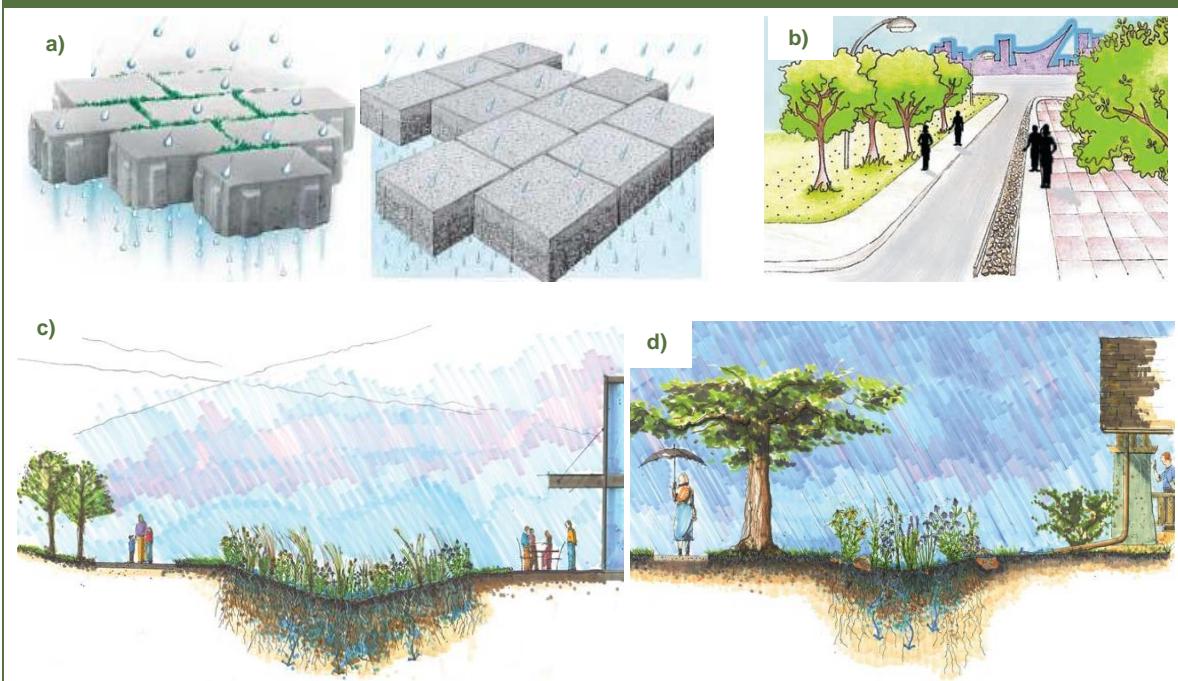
Estruturas de drenagem sustentável: a) Pavimentos permeáveis; b) Trincheira de infiltração; c) Vala de infiltração; d) “Rain garden”.
